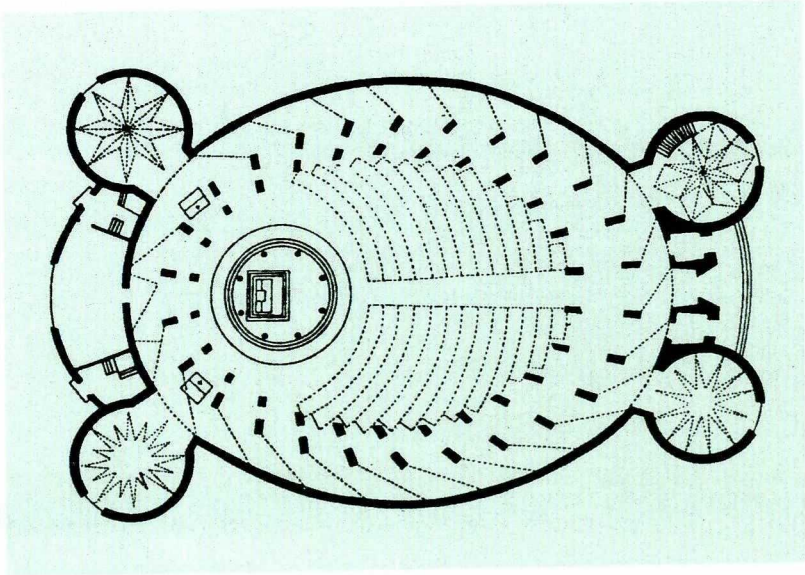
Entwurf „Melchiorkirche Circumstantes“, Grundriß
